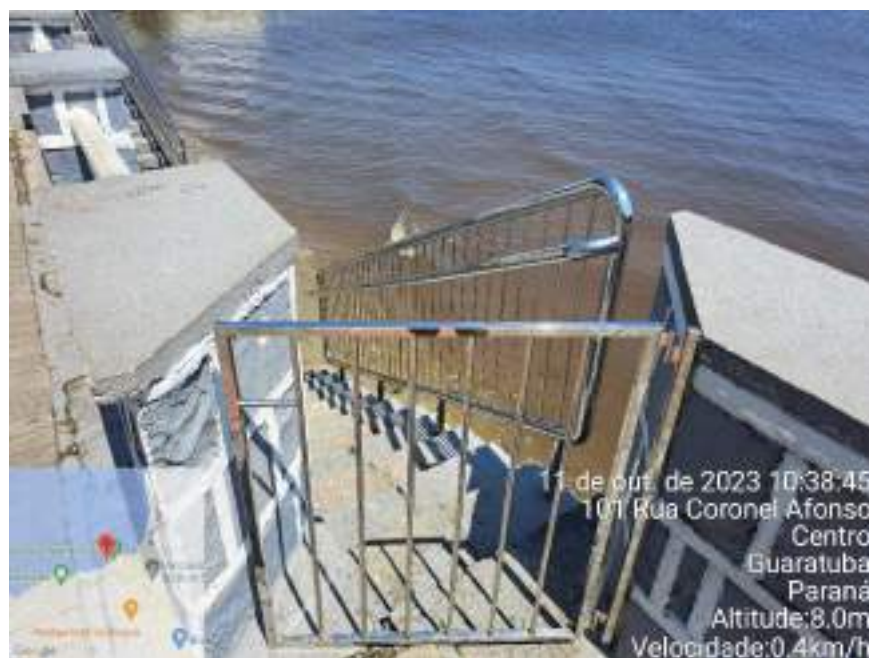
VISTA TRAVESSA JUVÊNIO UNHO
